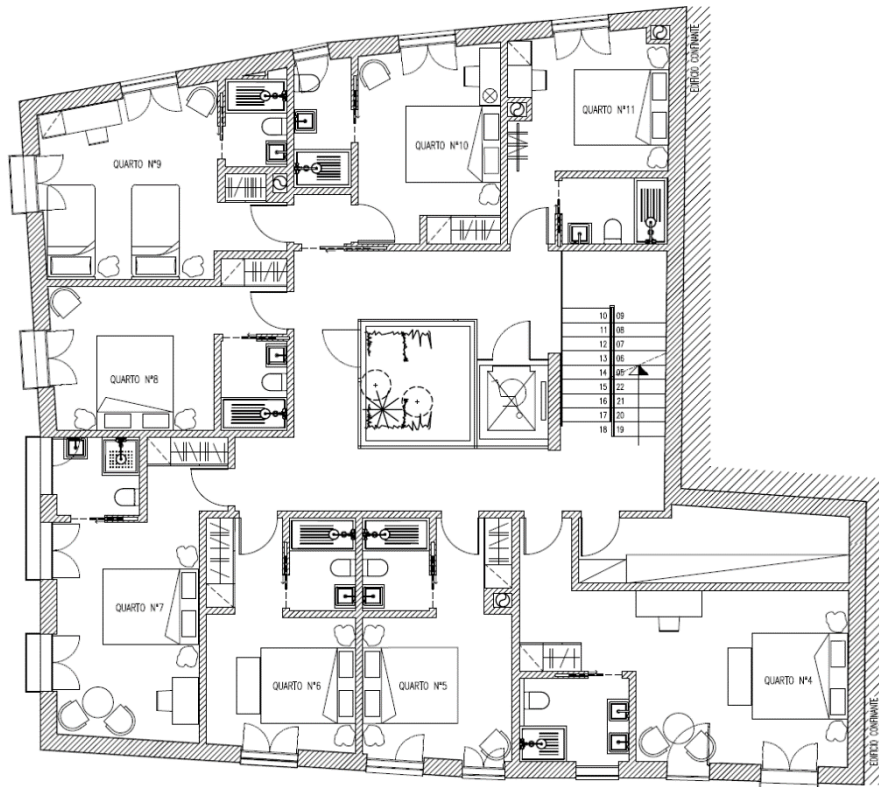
Planta de equipamento para o primeiro piso. Escala 1/100.
